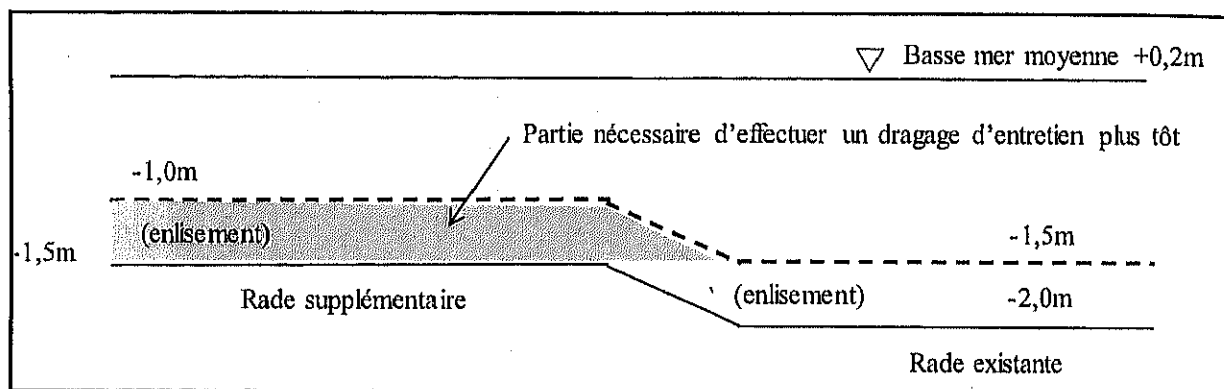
(8) Plan de conception de l'enlèvement de la rade et du dragage d'entretien
